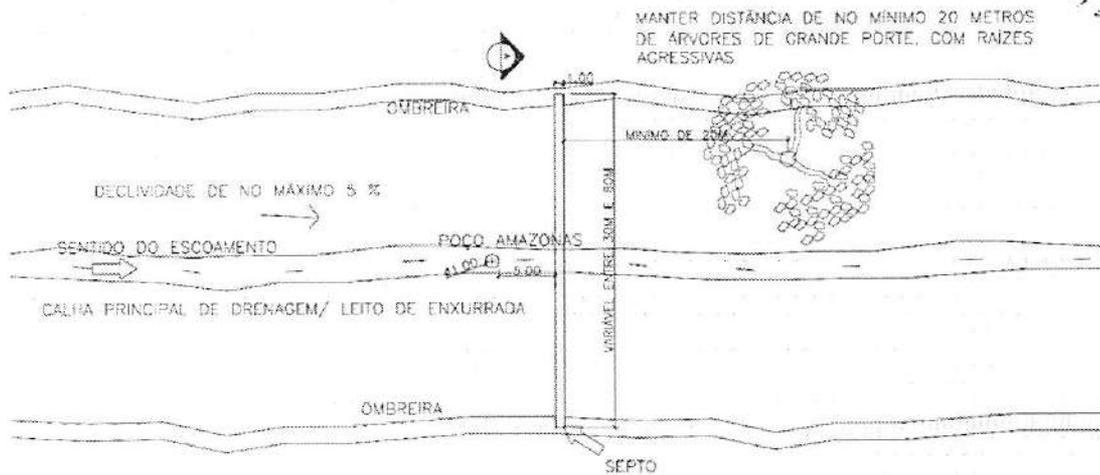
Planta baixa esquemática de uma barragem subterrânea
